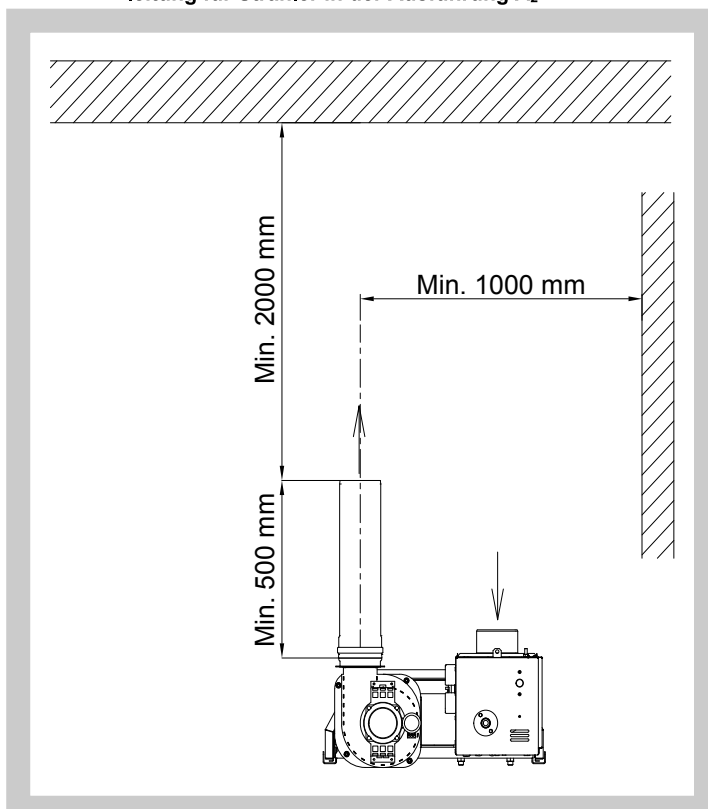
Abgasleitung und Verbrennungsluftzufuhr durch getrennte Rohrleitungen – Dachausführung
